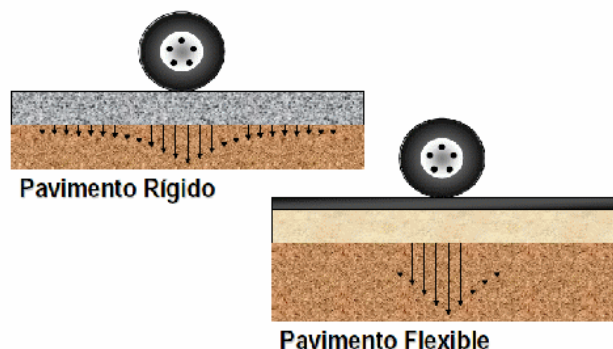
COMPORTAMIENTO MECANICO DE LOS TIPOS DE PAVIMENTO
